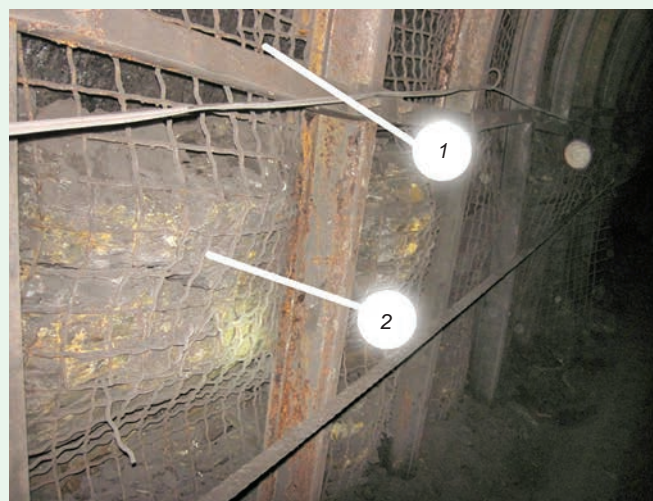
Выдавливание пород подошвы пласта выработки: 1 – уголь; 2 – аргиллит.
